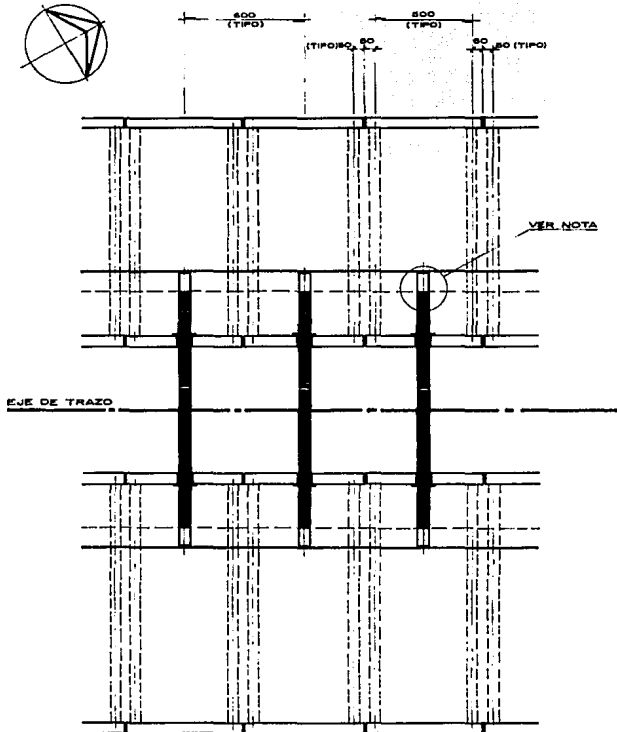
PLANTA DE LOCALIZACION DE APUNTAMIENTO
